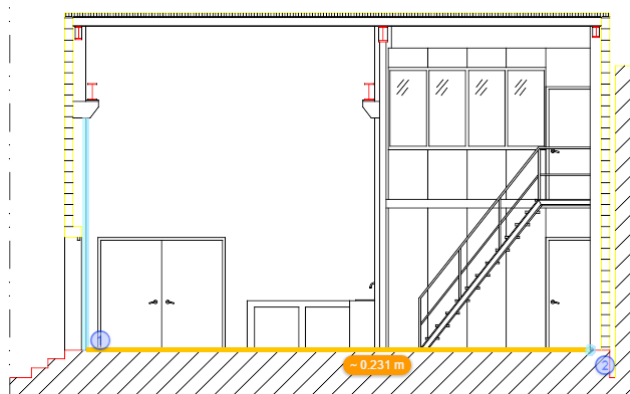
Largo de la Planta Piloto de la Facultad de Ciencias
